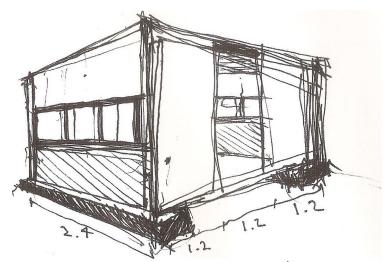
CROQUI DE PROJETO (MÓDULO 10X10). FONTE: S-AR (2006)
